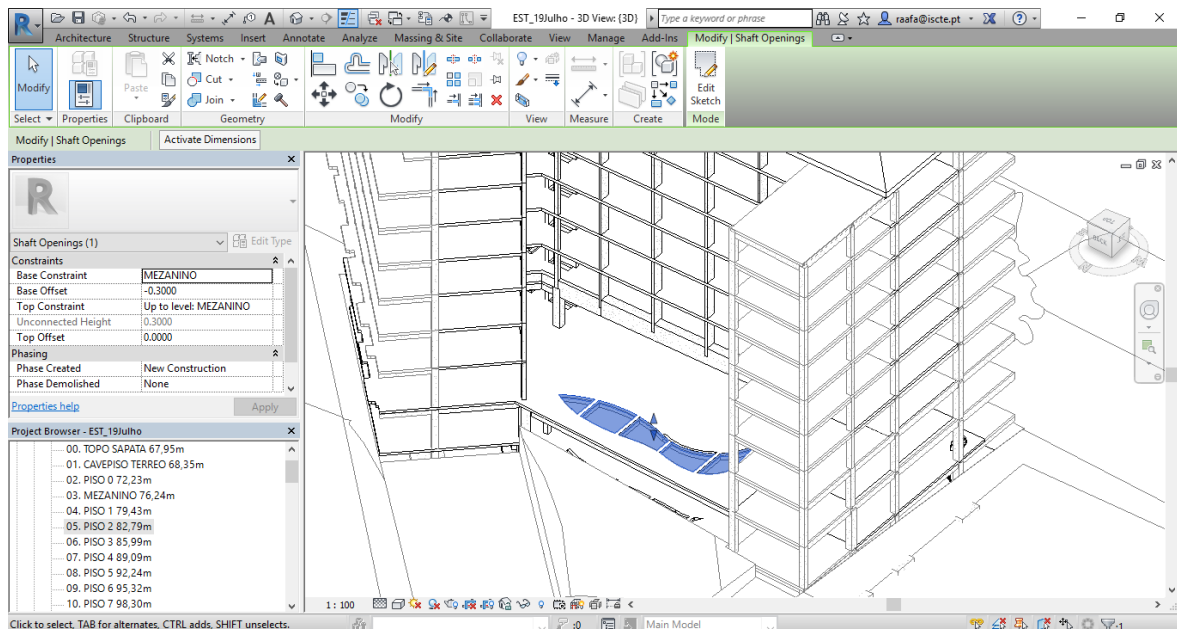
MODELO ESTRUTURAL COM DESTAQUE NA PERFURAÇÃO DE FORMA ORGÂNICA NA LAJE NA LAJE DE BETÃO DO TERRAÇO
